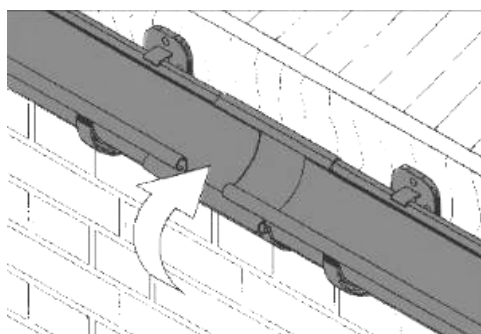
Montaż rynny w uchwytych [folder producenta]
